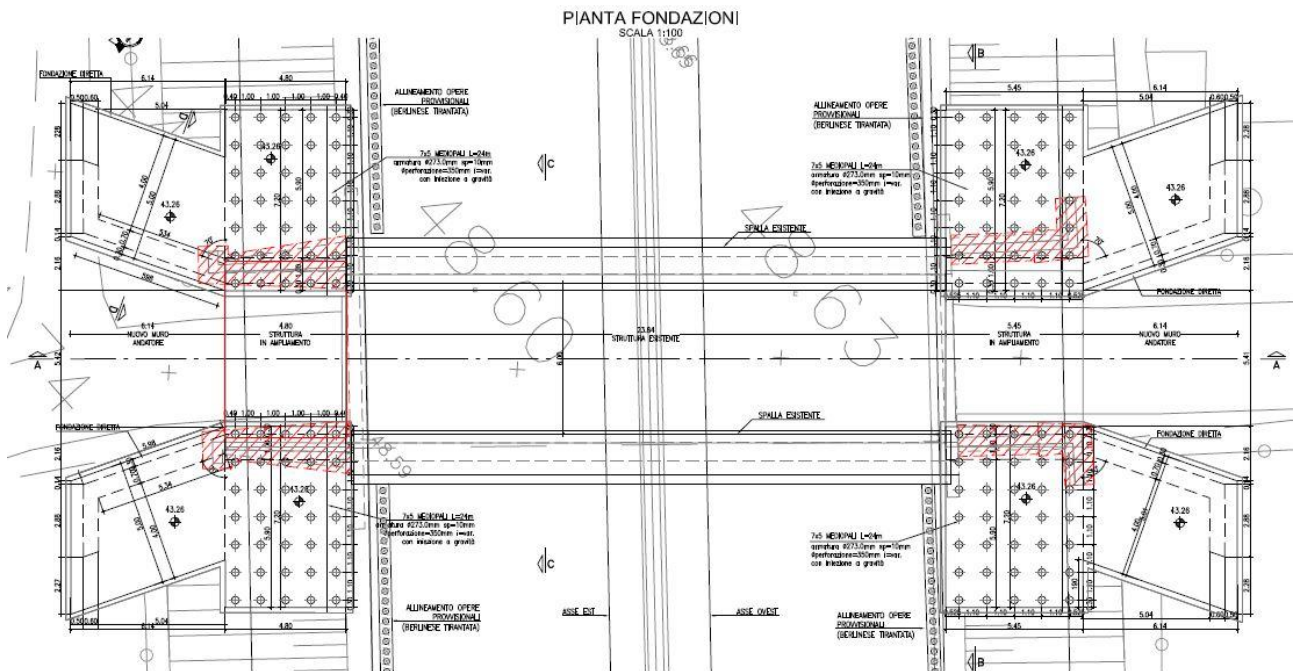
Planimetria di progetto opere di fondazione.
